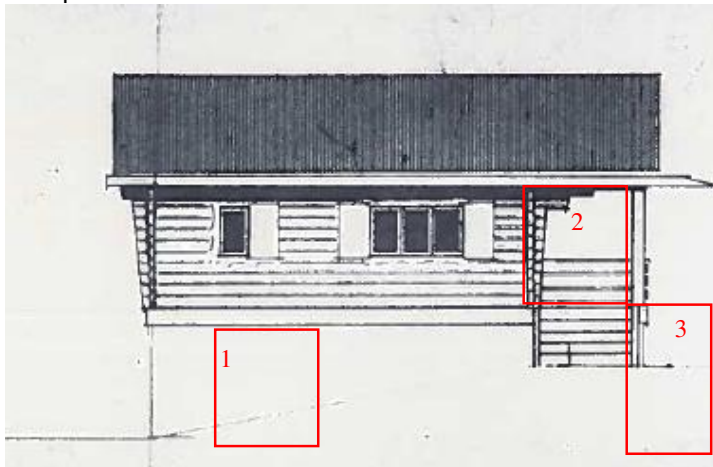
Estratto elaborato 2 – licenza 1973 con indicazione delle non conformità rilevate
